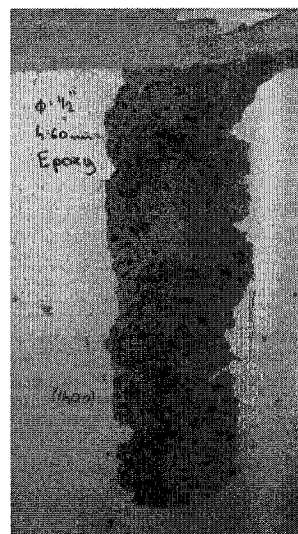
Photo des cônes d'arrachement des ancrages d'époxy de 60 mm de profondeur
